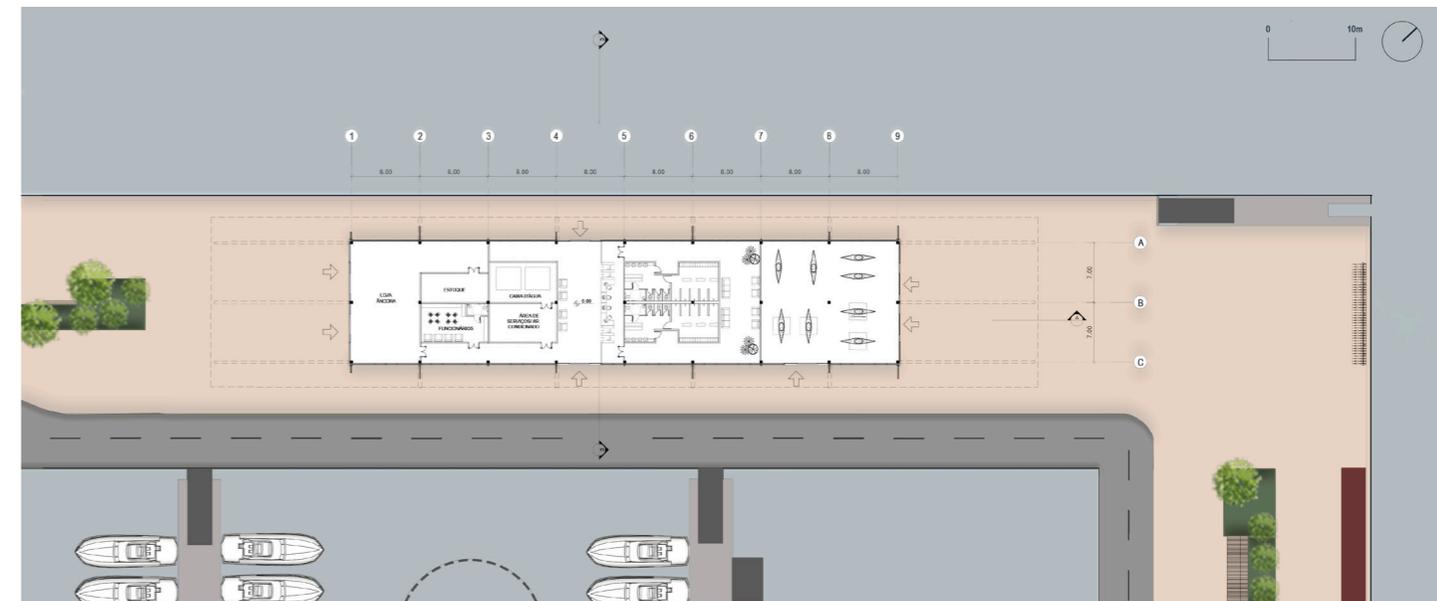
Planta Edifício Apoio Escola. Fonte: Autora,2021.
